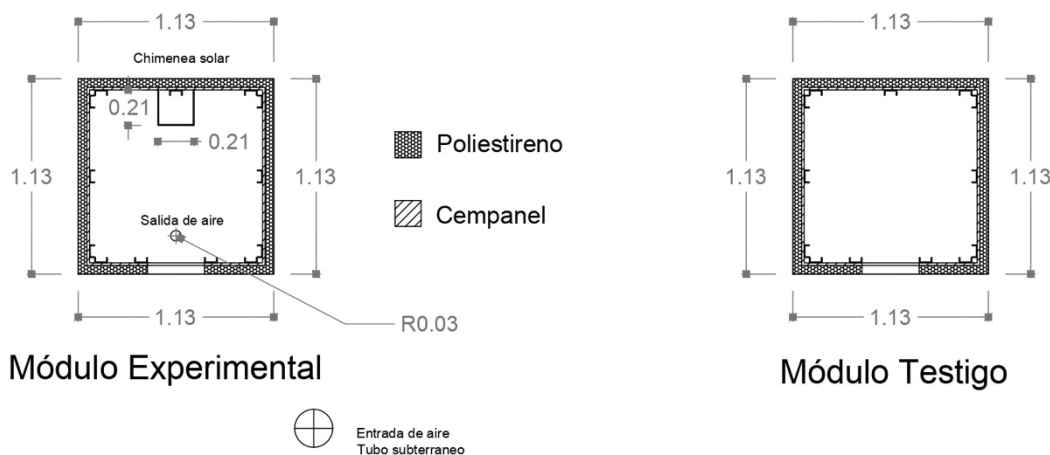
Planta arquitectónica, módulos de estudio. fuente: elaboración propia
